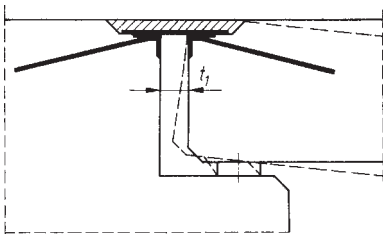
Horizontale Lagerung eines Trägers außerhalb der Lagerebene
